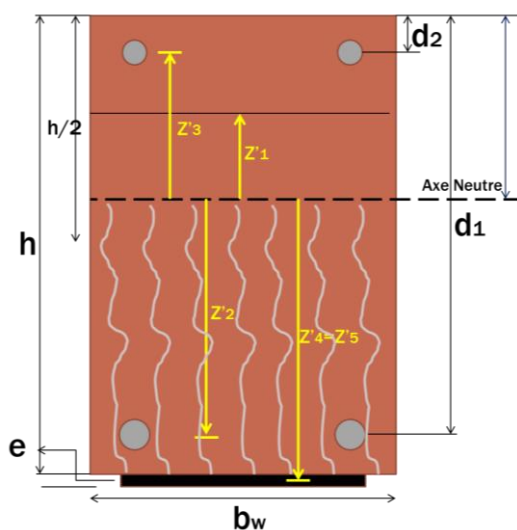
Axe Neutre de la section de la poutre fissurée
